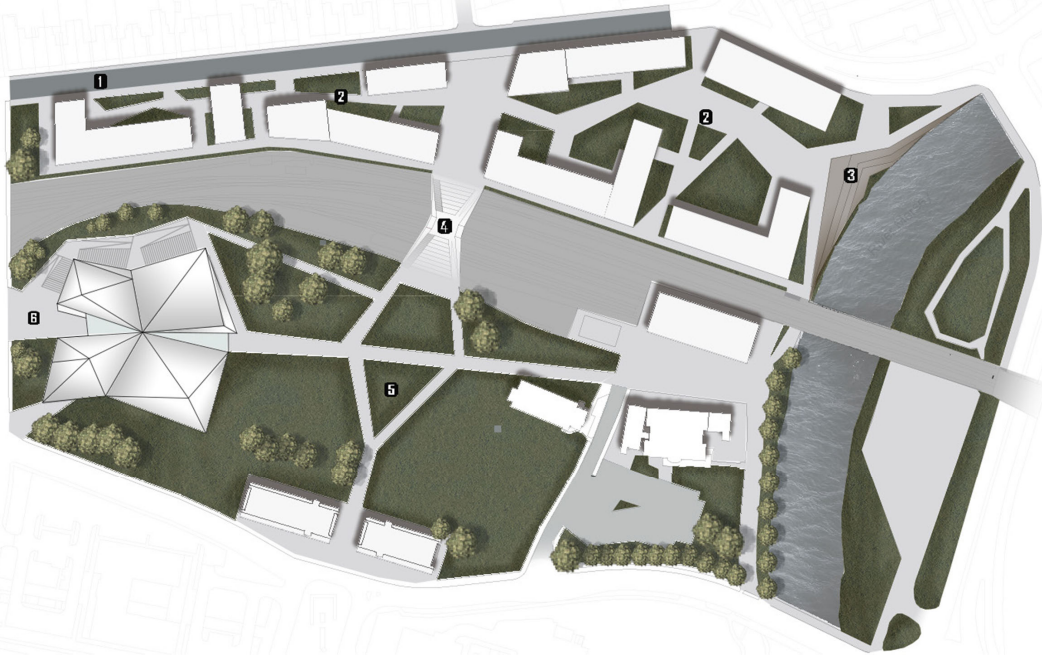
Master plan individual proposto. Fonte: Autora
